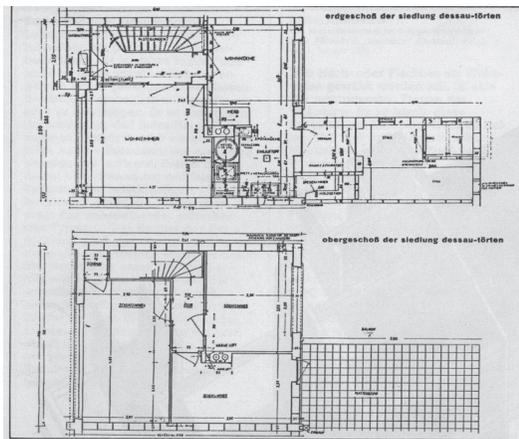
L-förmiger Grundriss der Reihenhäuser
